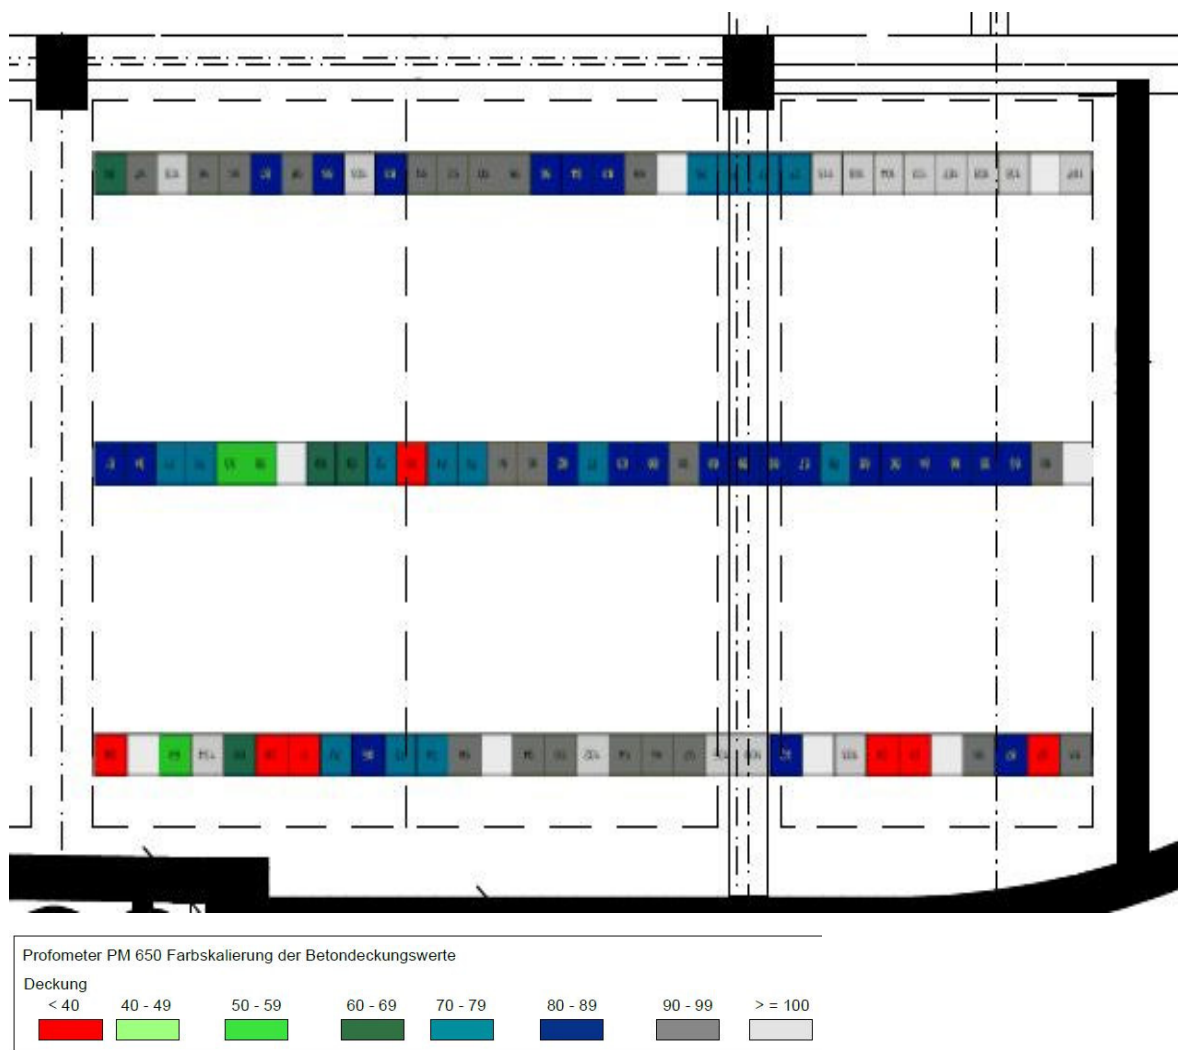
Auszug Übersichtsplan zur Betondeckungsmessung im Bereich der Parkergruben 03. UG, Achse 2-4/G-H
